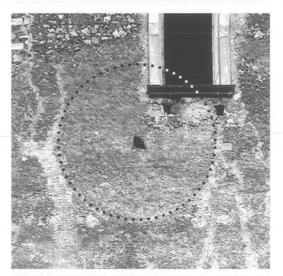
Prospetto ovest. Individuazione del rosone originario (foto dell'autore 2013)
